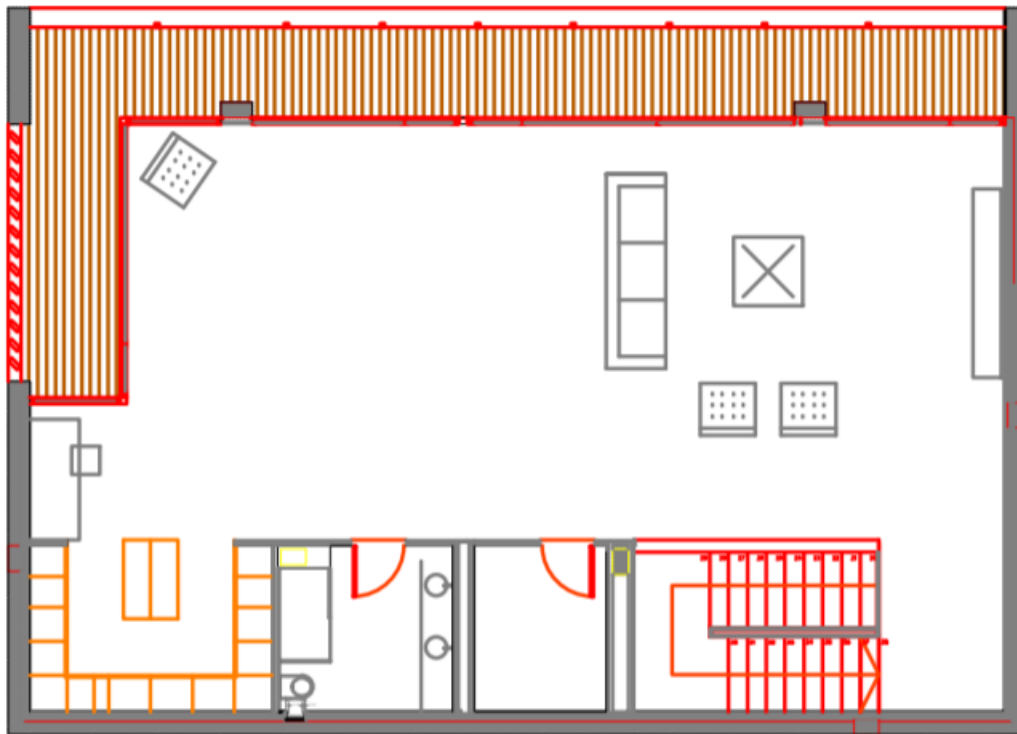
Elaboración propia. Plano de distribución de la planta primera de la vivienda.
